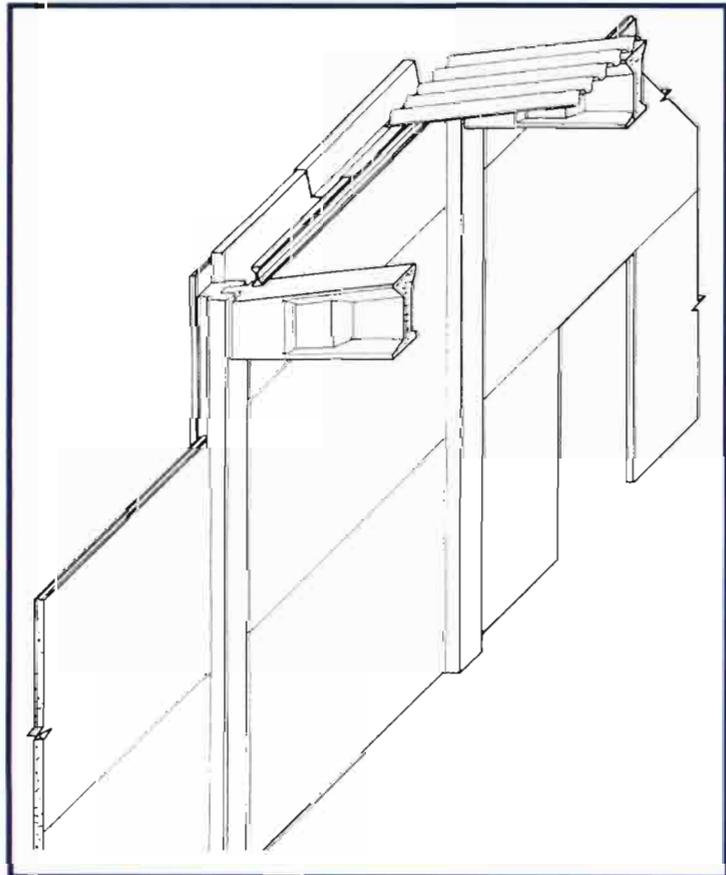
Cerramiento con paneles de hormigón prefabricado.
